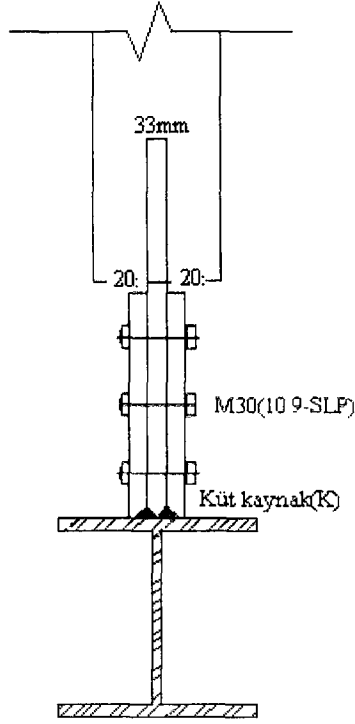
Profilin birleşim levhasına bağlantısının a-a enkesit detayı
